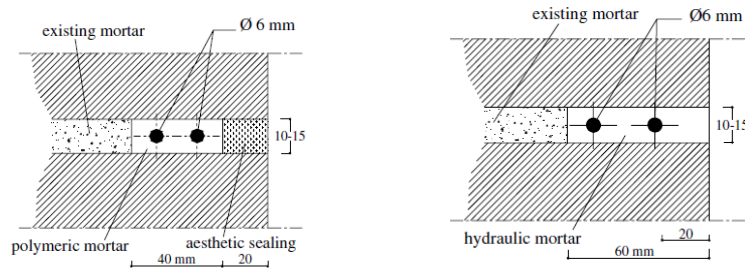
Détails des joints de mortier renforcés après le rejointoiement par mortier ou résines.
